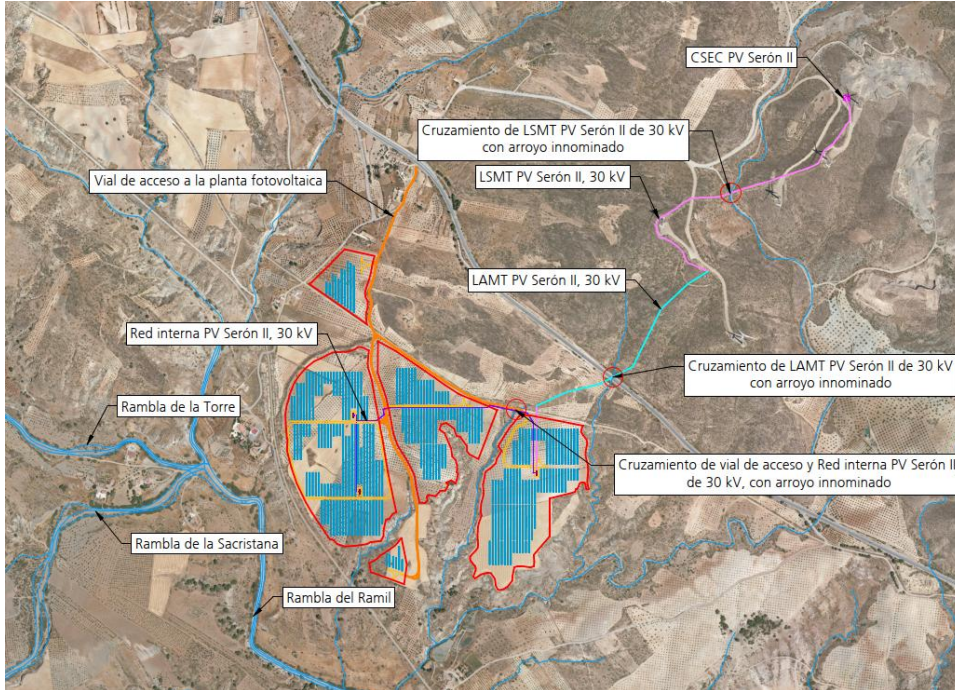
Arroyos próximos a la planta fotovoltaica. Fuente: Elaboración Propia.
